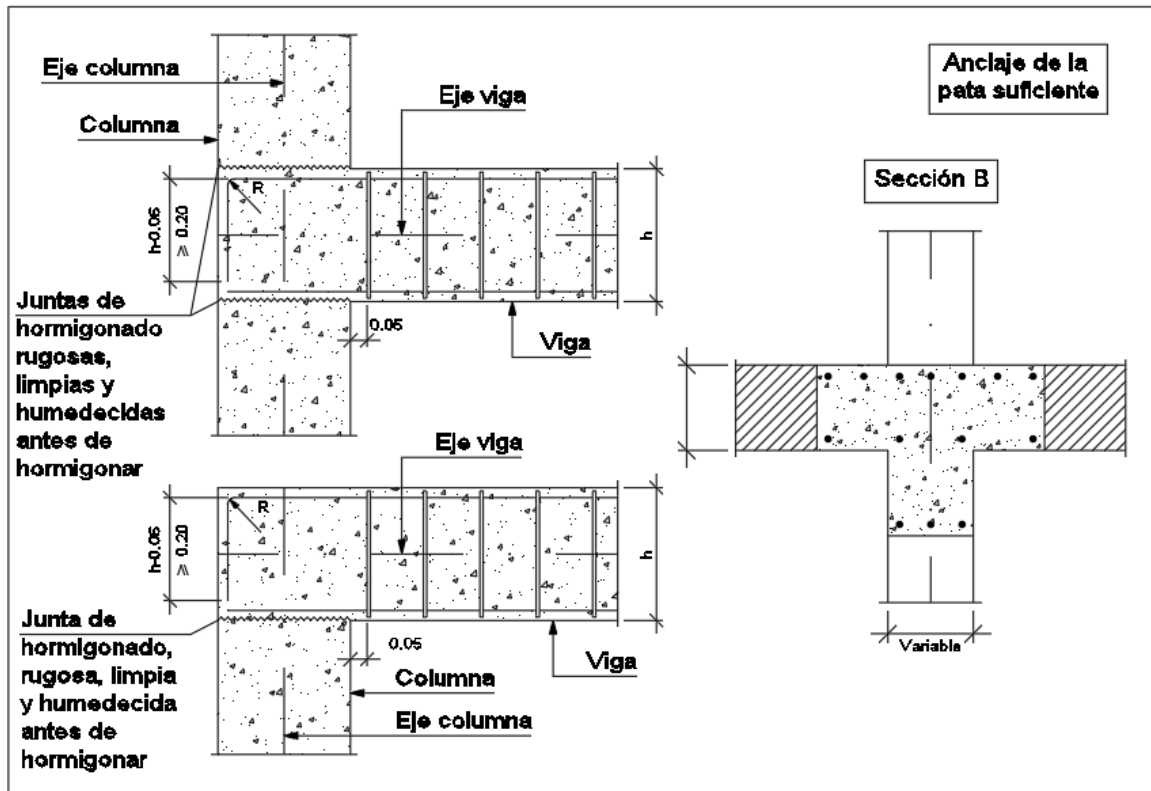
Detalle de cantidad de acero según tipo de columna
